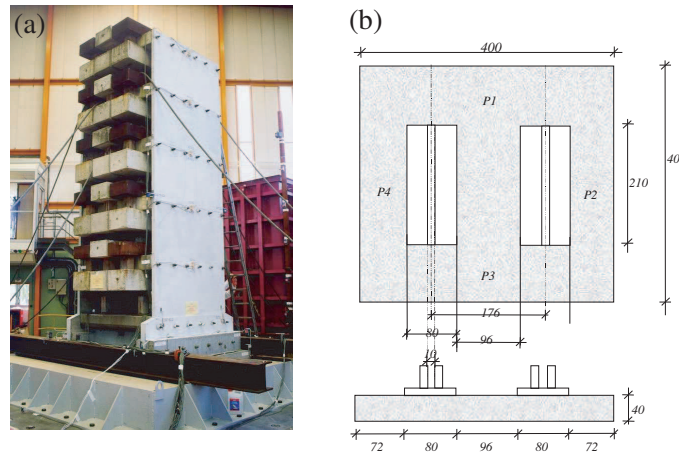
(a) Photo et (b) schéma de la fondation pour les essais Camus IV.
